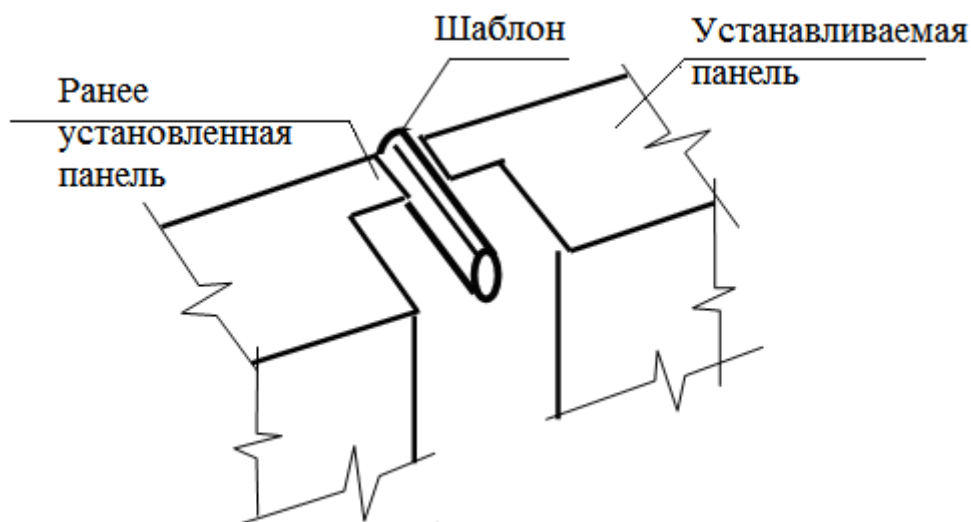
Установка панелей в поперечном направлении при ломаном фасаде
